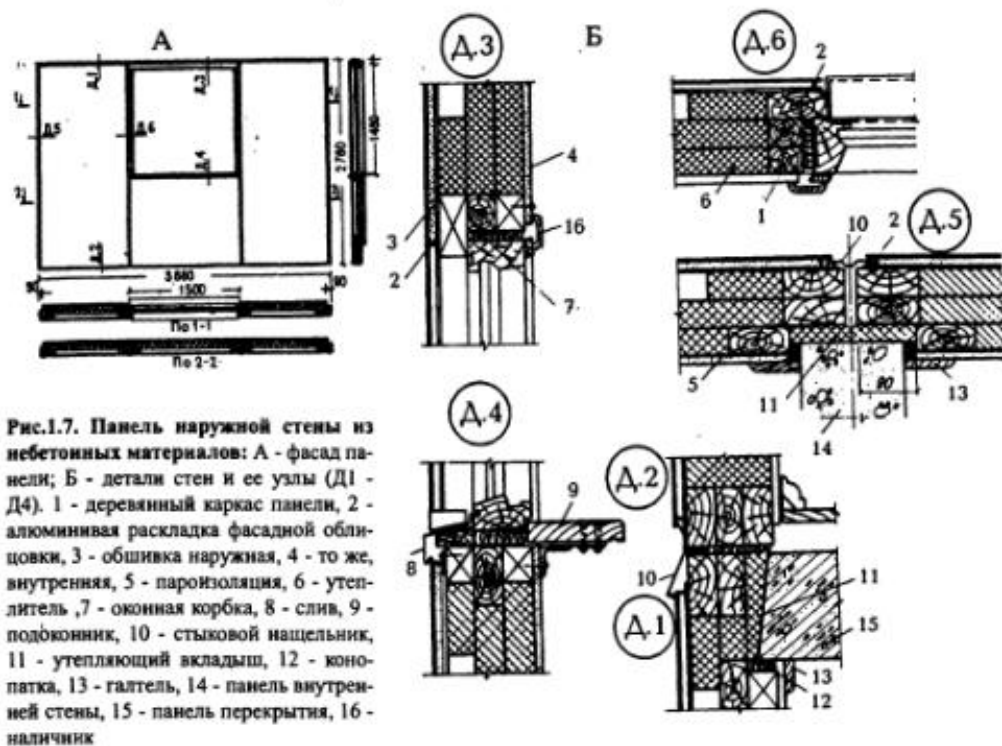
Панель наружной стены из небетонных материалов: А - фасад панели; Б - детали стен и ее узлы (Д1 - Д4). 1 - деревянный каркас панели, 2 - алюминиевая раскладка фасадной облицовки, 3 - обшивка наружная, 4 - то же, внутренняя, 5 - пароизоляция, 6 - утеплитель, 7 - оконная коробка, 8 - слив, 9 - подоконник, 10 - стыковой наличник, 11 - утепляющий вкладыш, 12 - конопатка, 13 - галтель, 14 - панель внутренней стены, 15 - панель перекрытия, 16 - наличник
